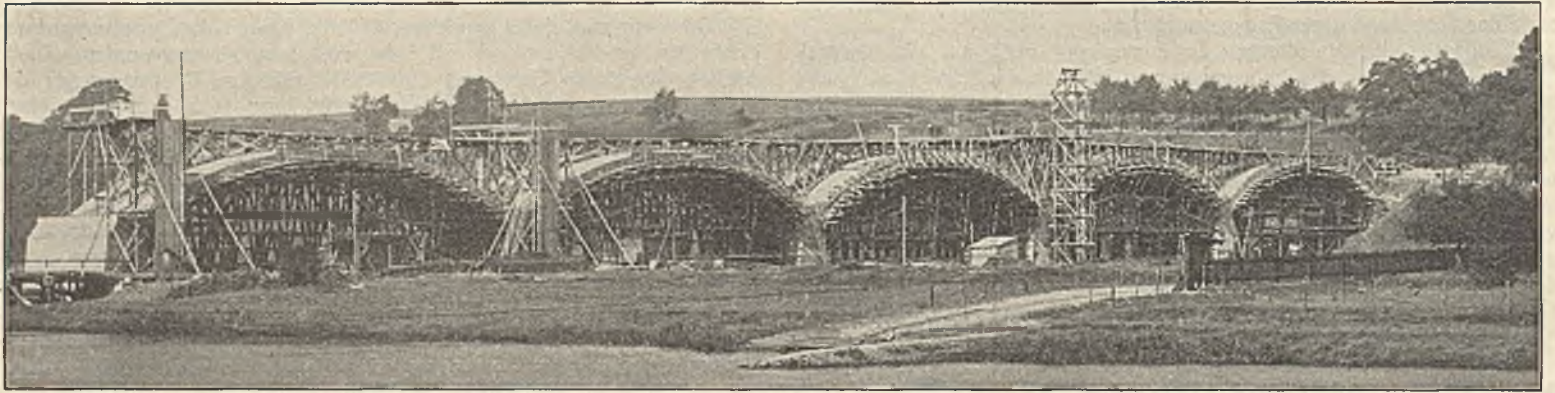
Flutöffnungen der Ruhrbrücke Blankenstein während der Einrüstung und Betonierung.
